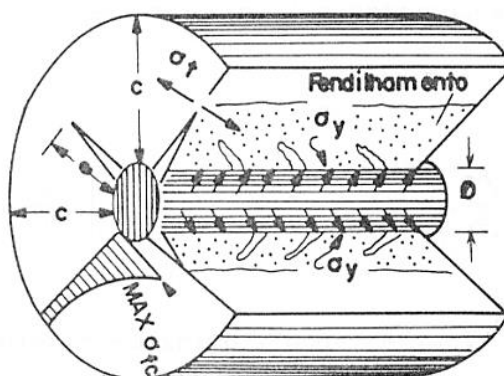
Esquema de ruptura por arrancamento em barra lisa - Goto (1971).
